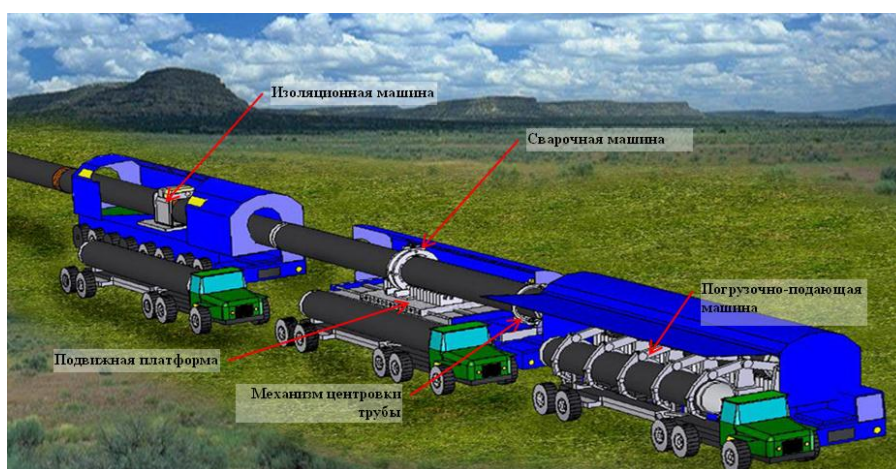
Автоматизированный мобильный комплекс для лазерной сварки стыков трубопроводов в полевых условиях
